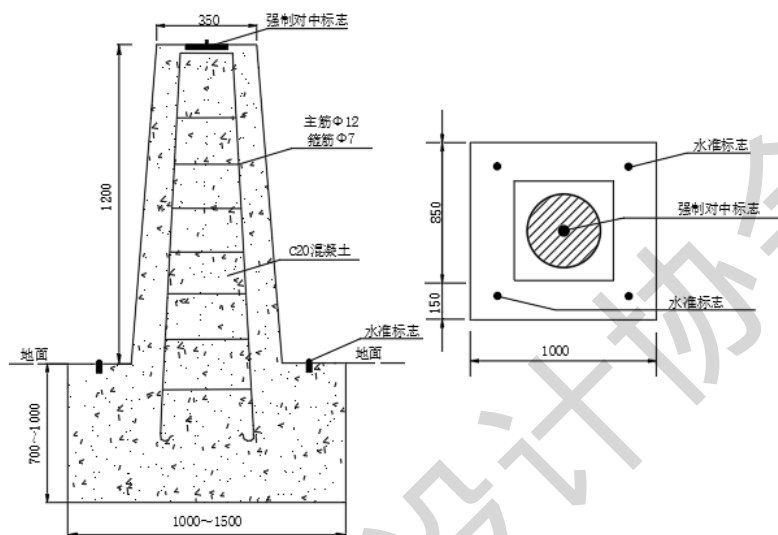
土层水平位移观测墩剖面图与俯视图（单位：mm）
